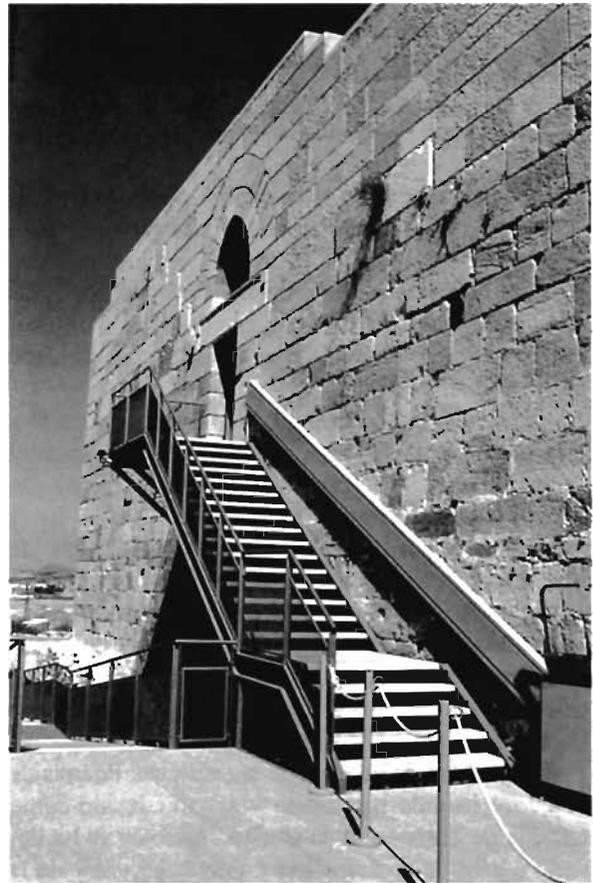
Acceso de la Torre del Homenaje, que alberga en su interior un centro de interpretación de la ciudad.
